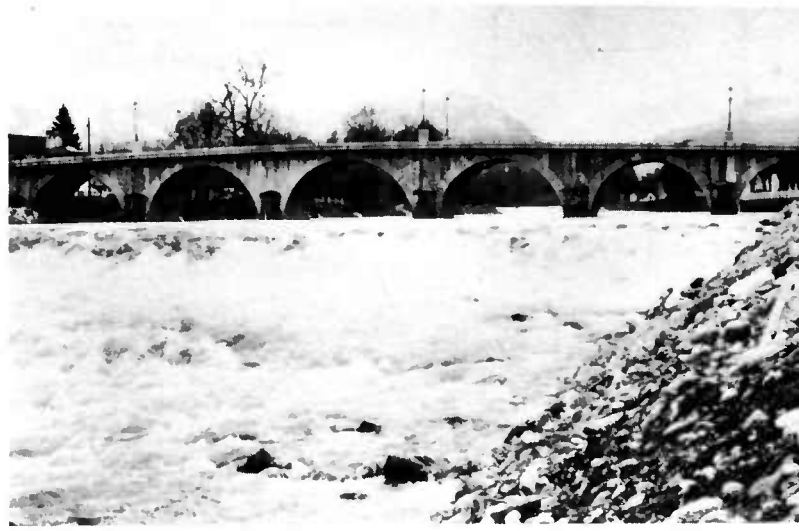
Pont de Nay - Le seuil et l'ouvrage.
